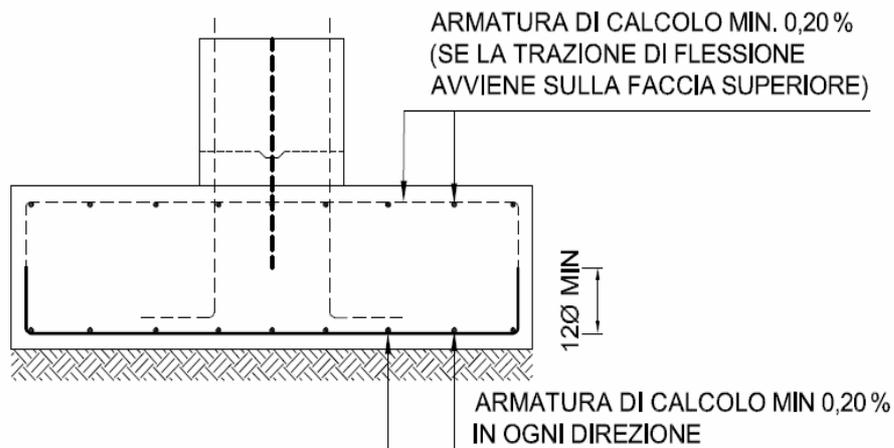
Particolari costruttivi: fondazioni di pilastri.
